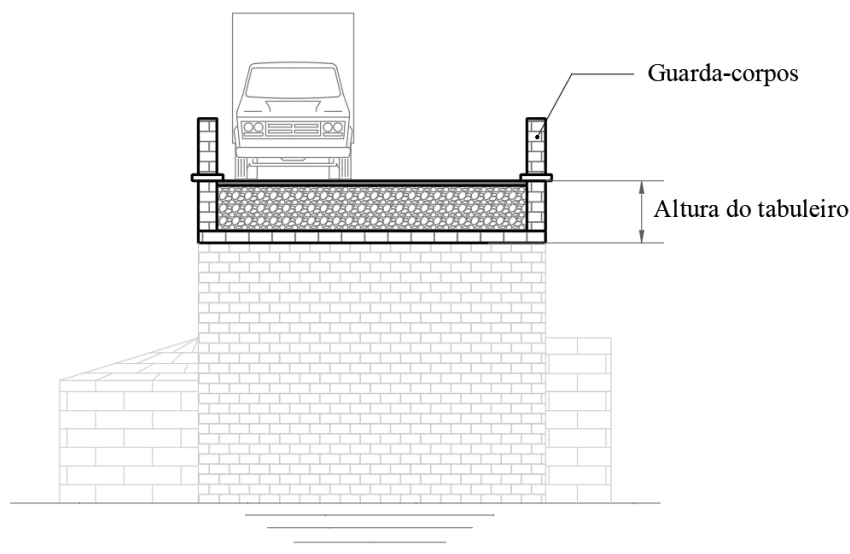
Definição de tabuleiro em obras de arte em arco de alvenaria de pedra (corte transversal)
